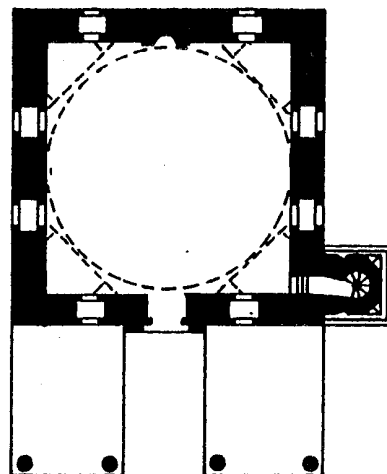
مسقط أفقي لجامع اورخان غازي
